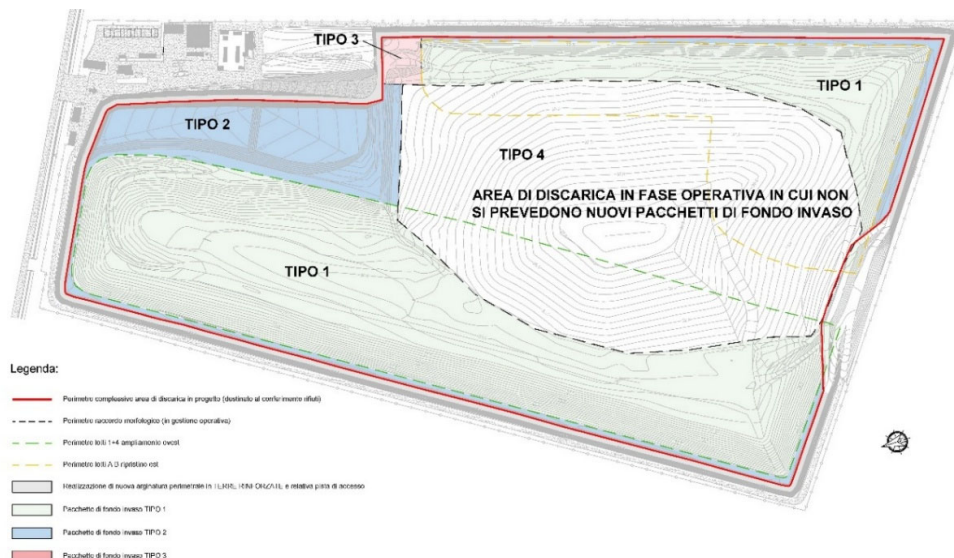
Planimetria generale con indicazione dei 4 areali di intervento
